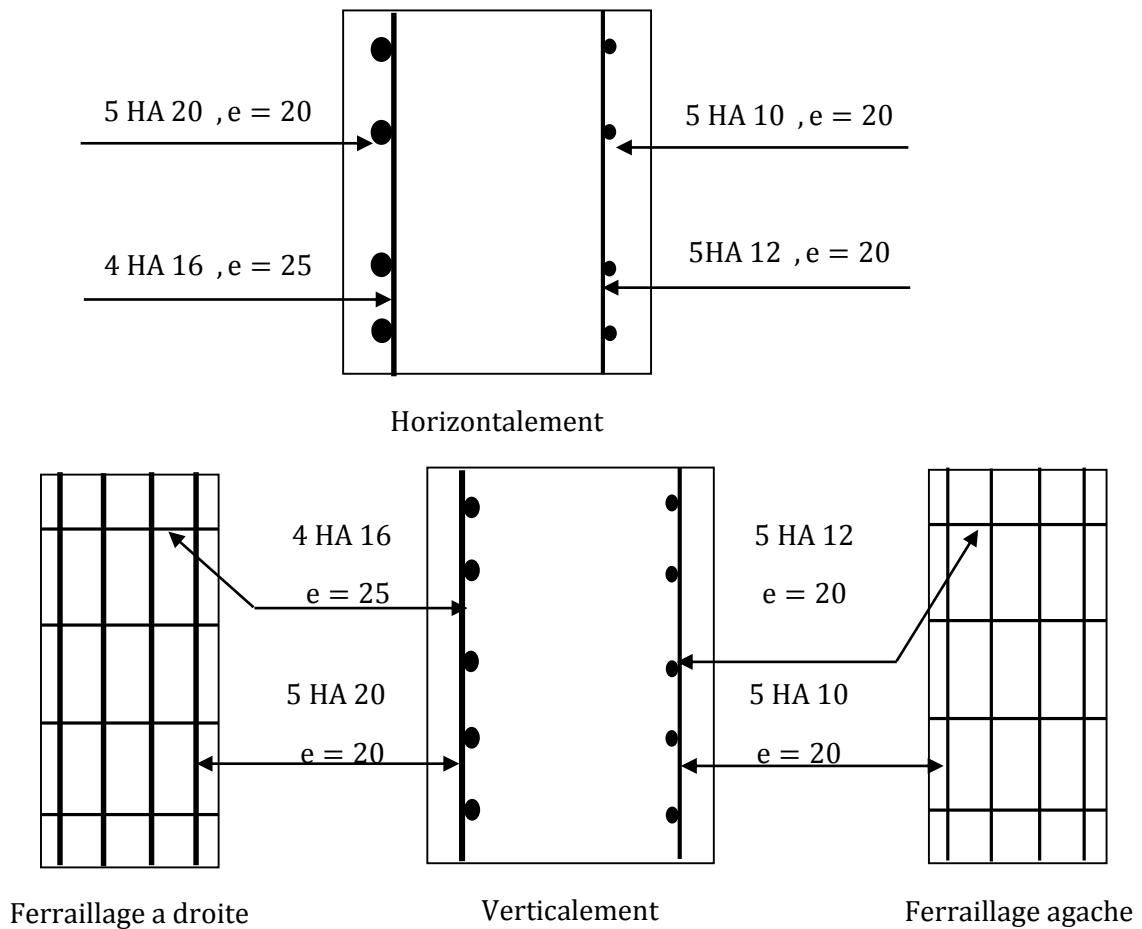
Schéma de Ferrailage du mur frontal.
